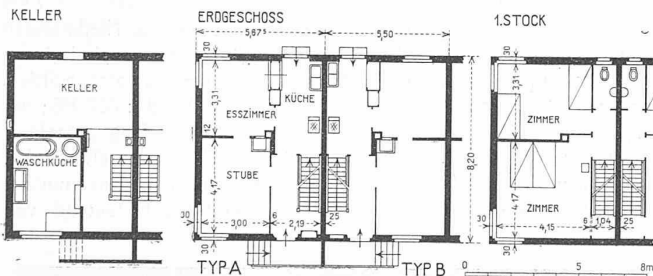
Grundrisse von Typ A und B. — Masstab 1 : 300.
